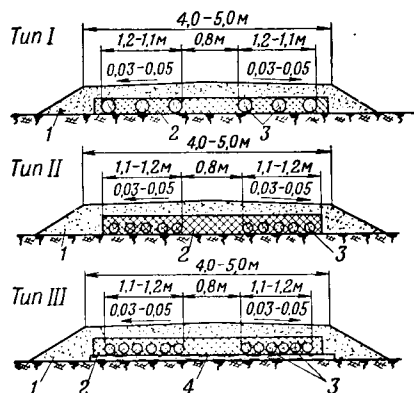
Конструкция усов с хворостяной выстилкой с засыпкой ее дренарующим грунтом:
